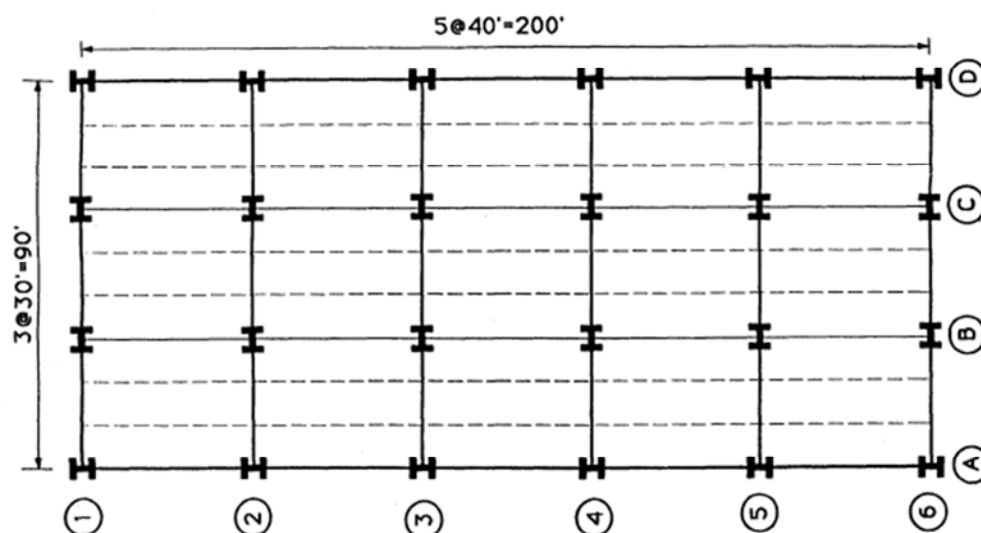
Vista en planta del edificio en estudio (Itani y Goel, 1994)
